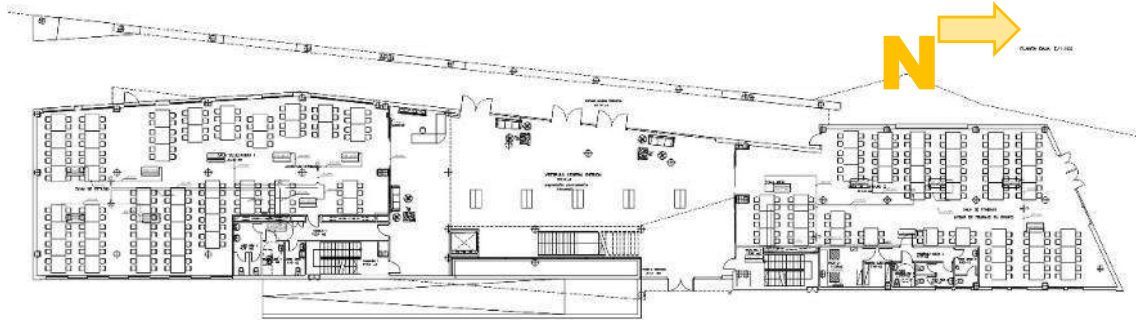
Planimetría nueva Biblioteca Rector Marchado y Núñez
